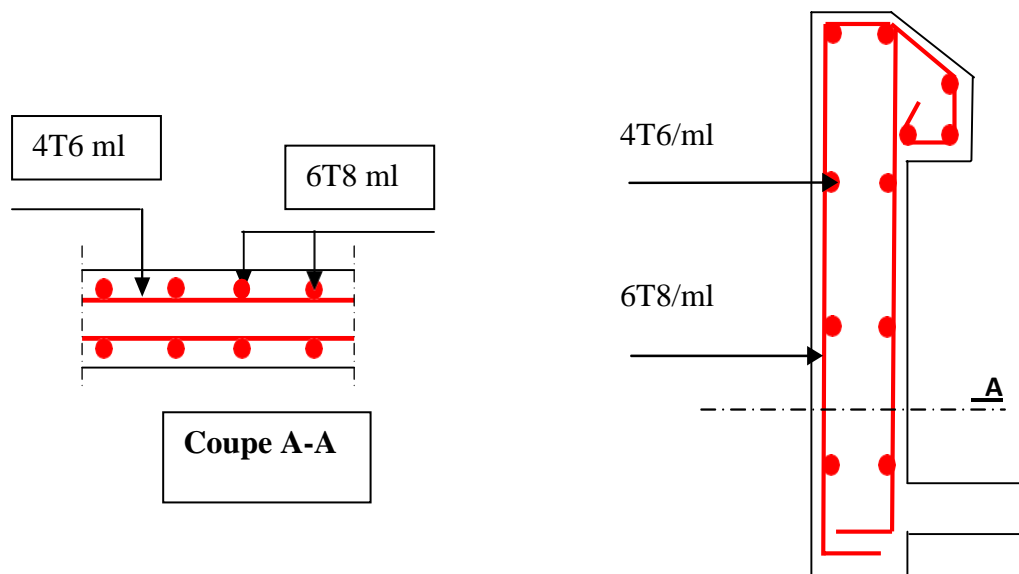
Schéma de ferrailage de l'acrotère.
